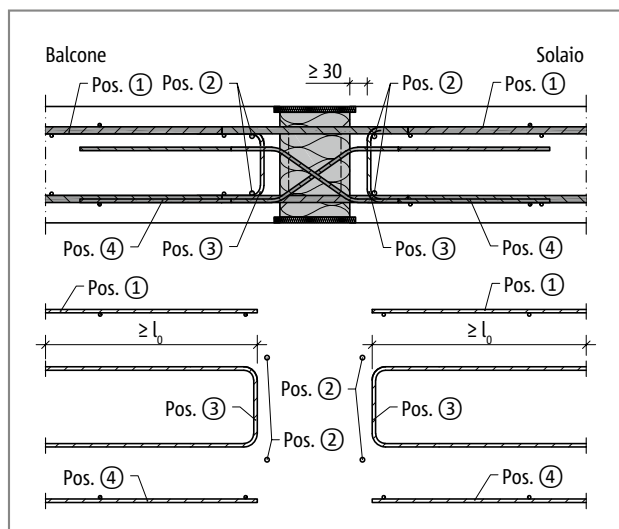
Schöck Isokorb® XT tipo DL: armatura in opera
